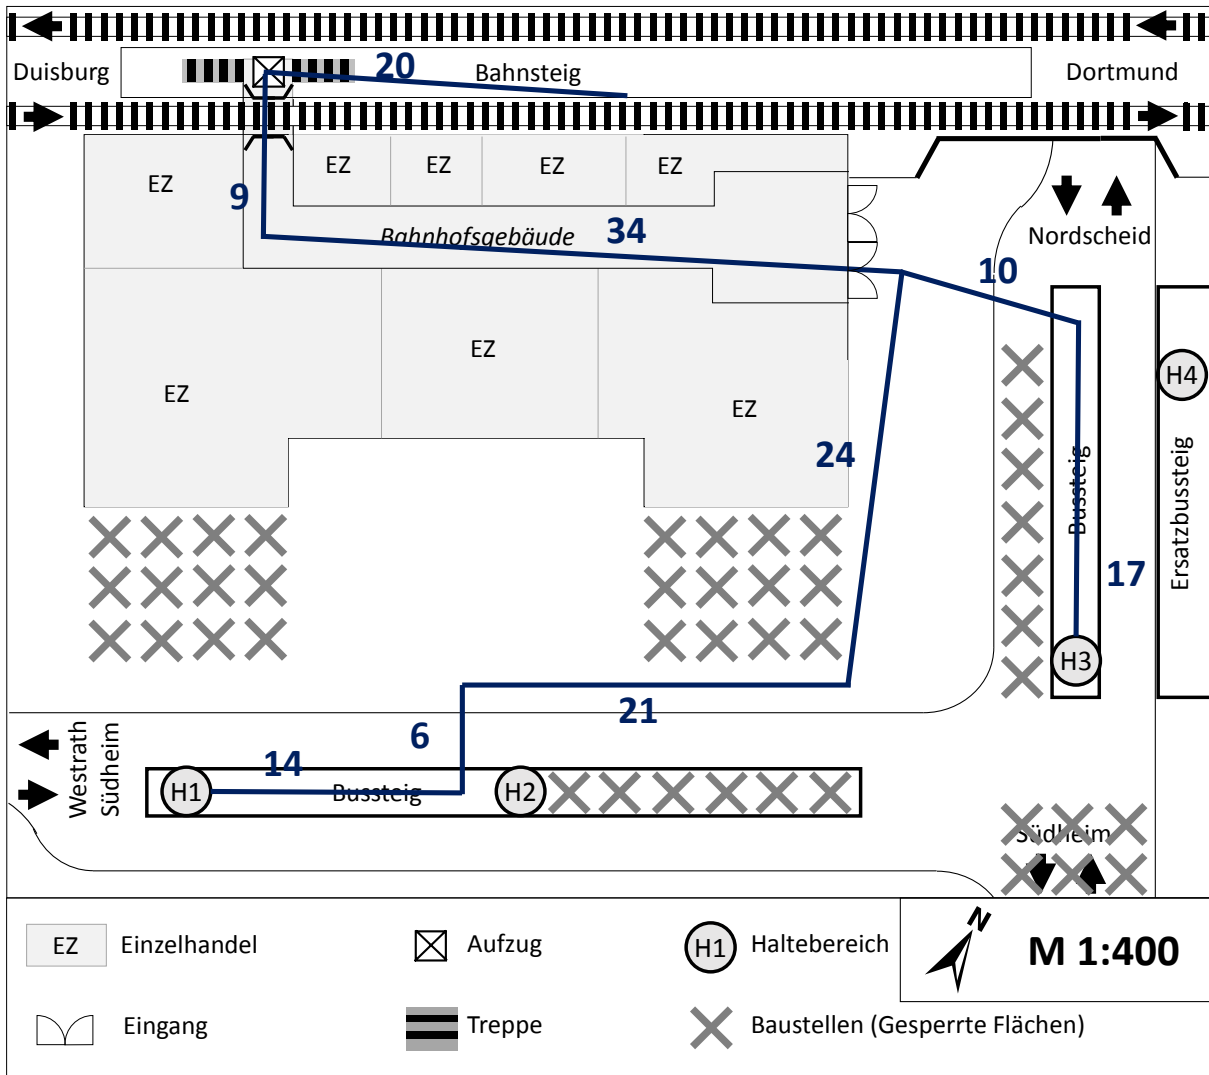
Lageplan des Bus- und Bahnhofs
